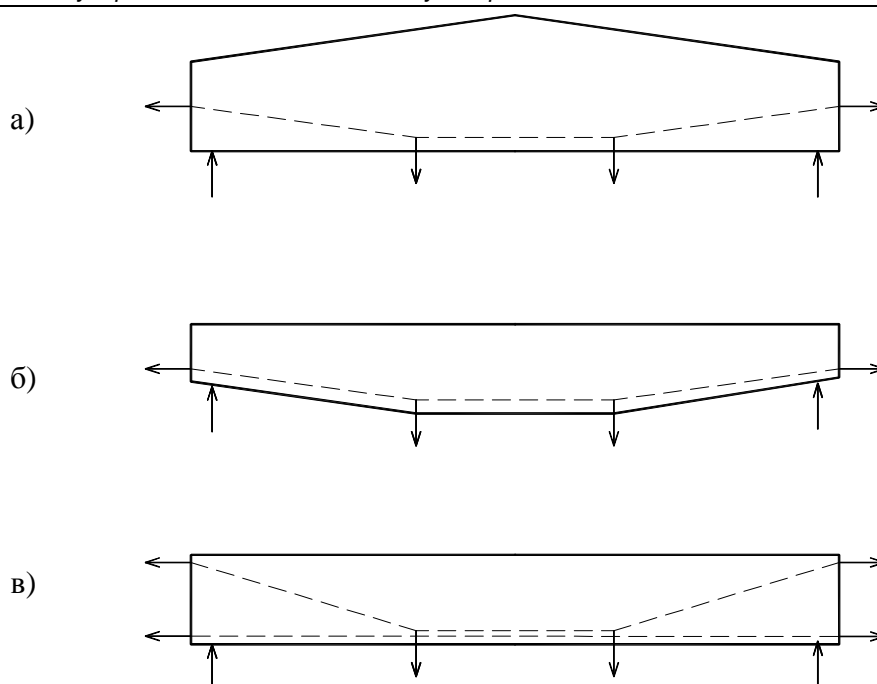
Схемы армирования отогнутой напряженной арматурой
